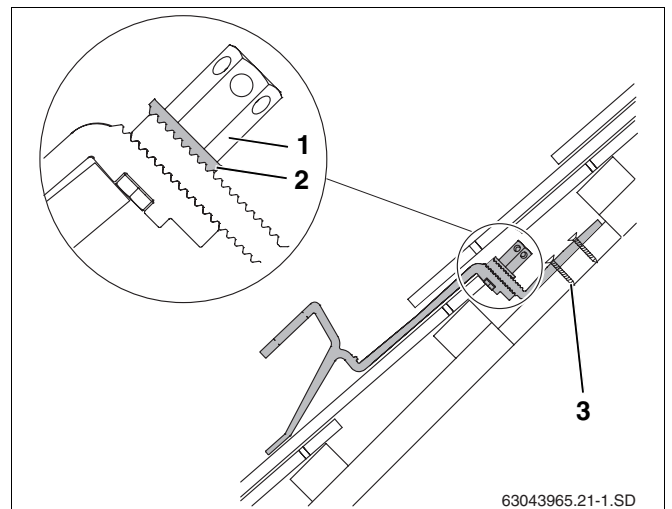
Gancho para telhados instalado – apresentação de secção com parte inferior do gancho para telhados encurtada
